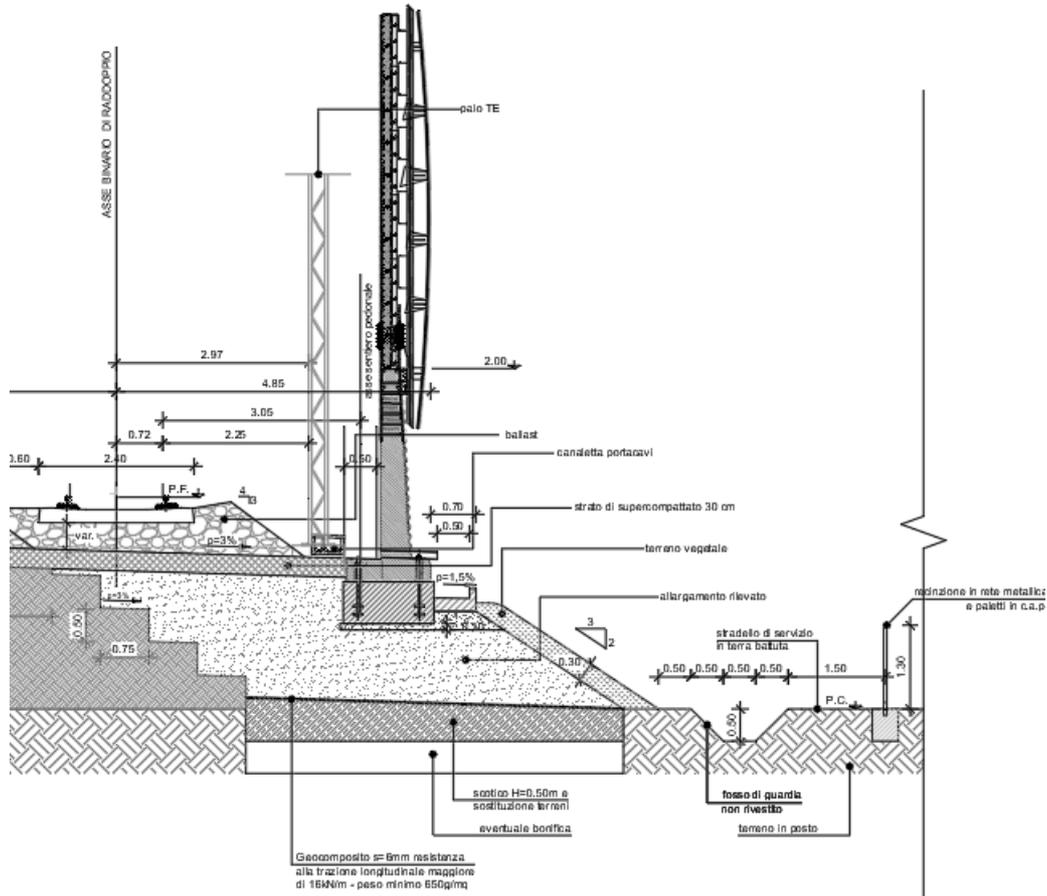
Sezione tipo con barriera antirumore lato binario di progetto.
